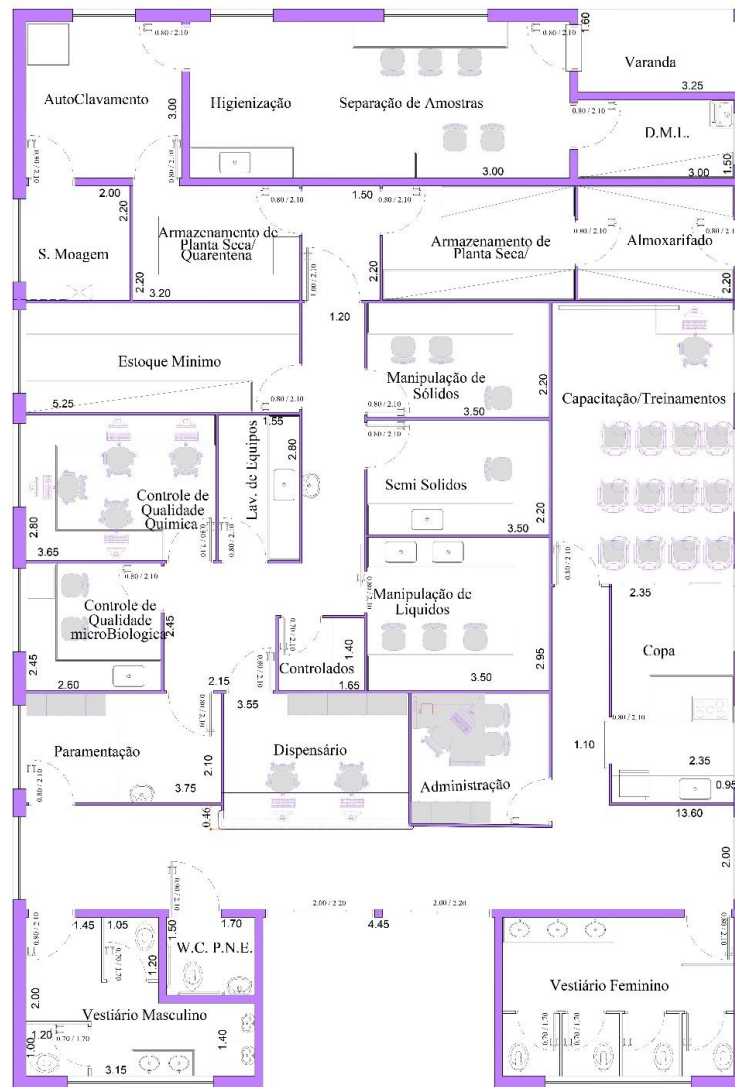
Planta baixa da Farmácia Viva de Piacatu.
